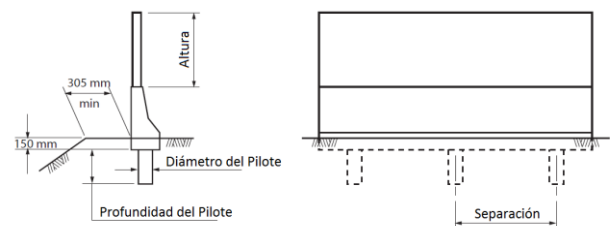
Fundación sobre pilas⁽¹⁷⁾
